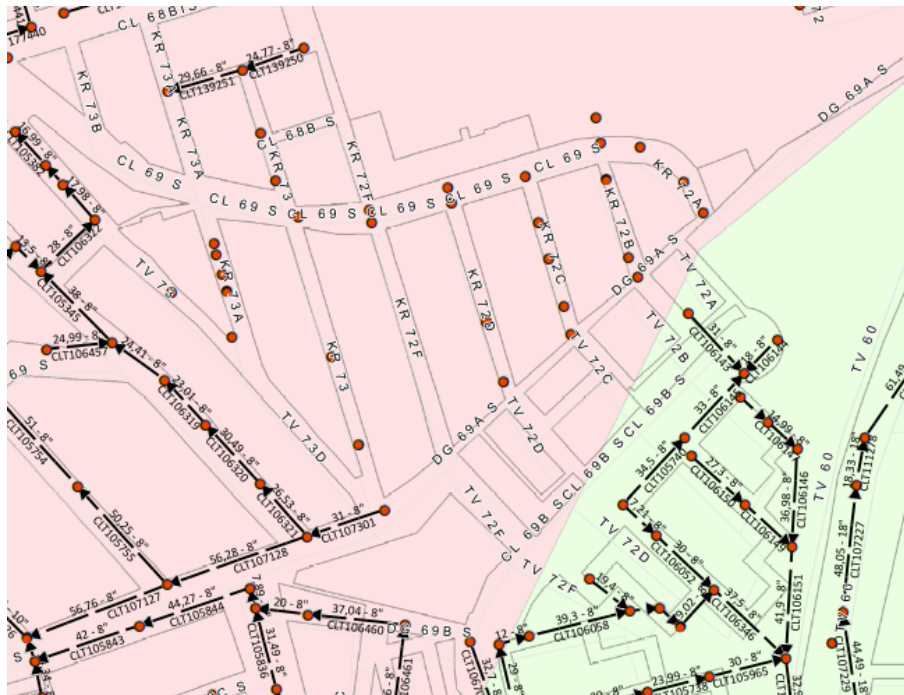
Red de Alcantarillado Combinado en la zona de estudio. Fuente: Plancha L-14 suministrado por la Empresa de Acueducto y Alcantarillado de Bogotá – EAAB. 2018.
